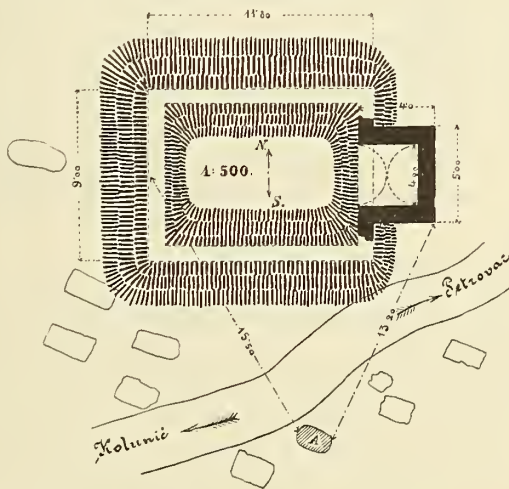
Grundriss der Kirchenruine Panagjur bei Kolunići.
